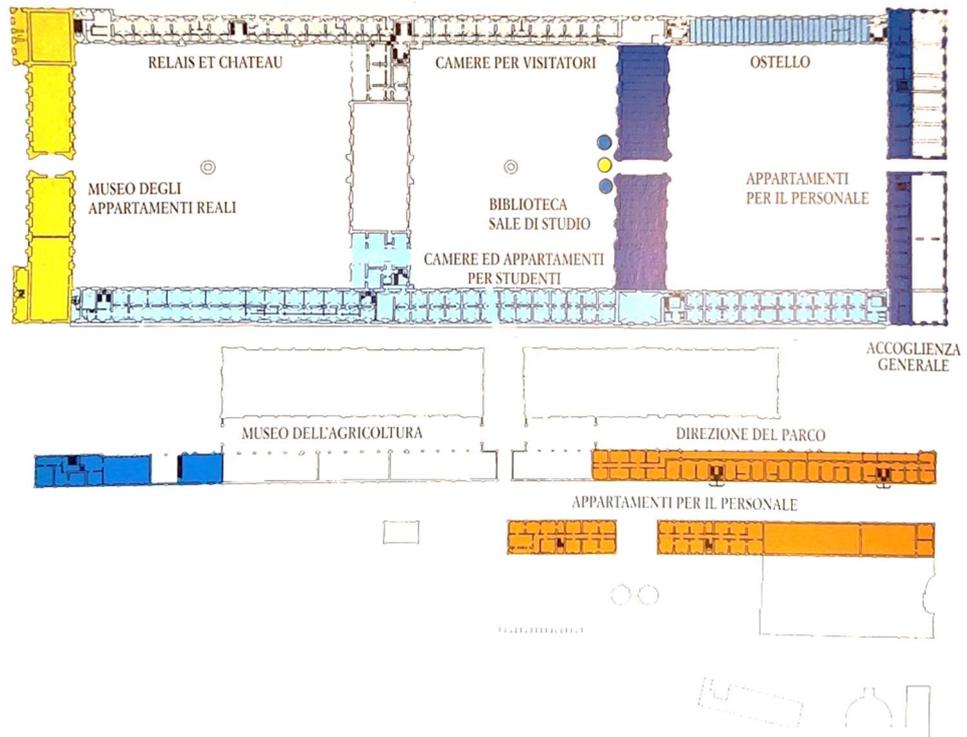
Complesso di Borgo Castello. Pianta piano ammezzato. Estratto
